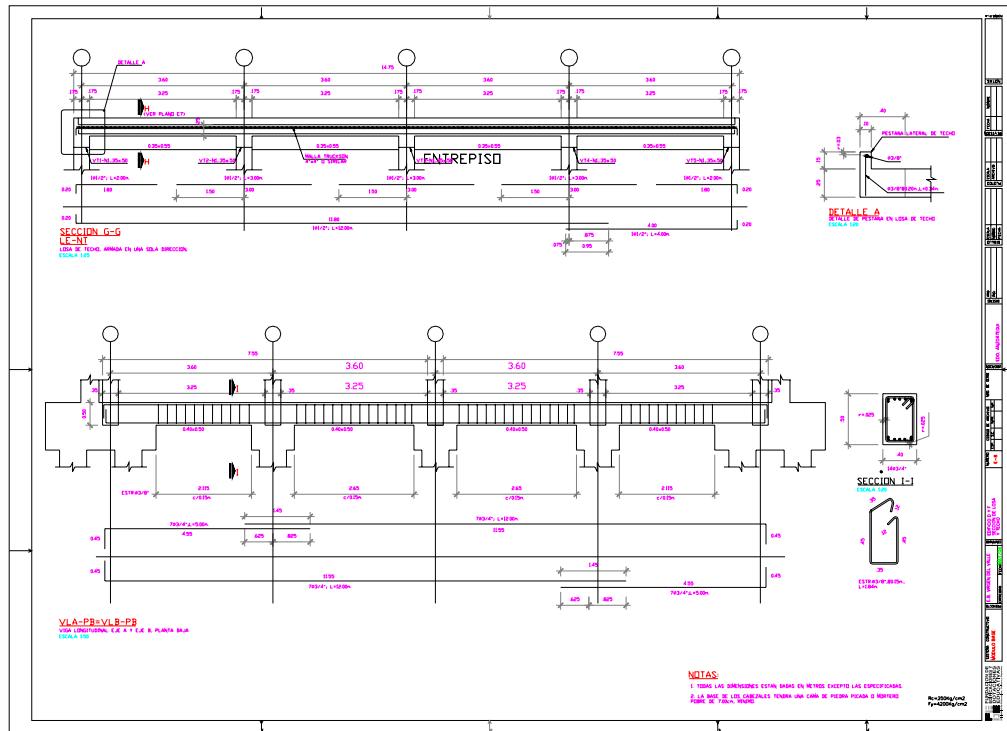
Edificio D y F. Sección de losa y techo. Modulo de Base.
